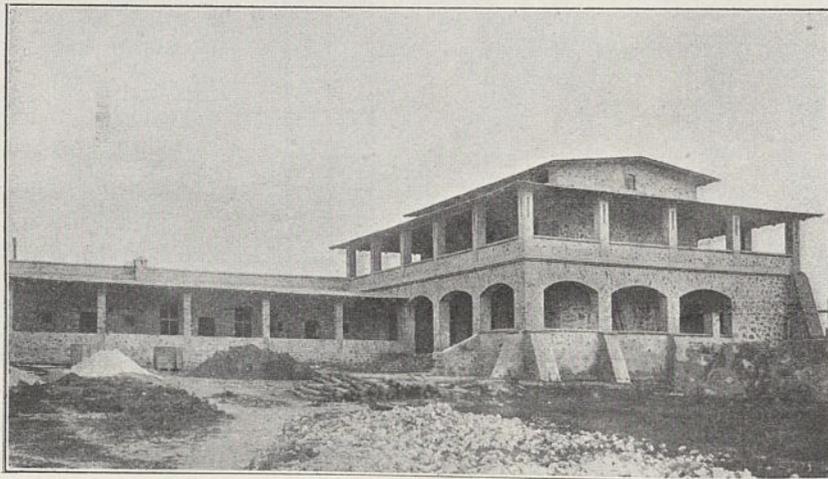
Stationsbau in Tabora. Offizierhaus.
